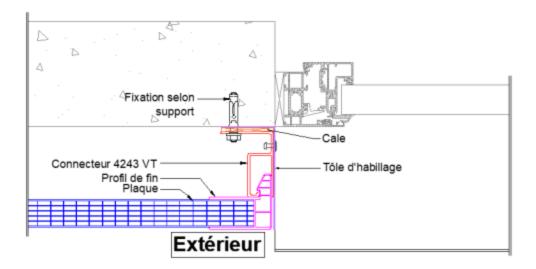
Encadrement d'une baie en tunnel avec plaque ajustée - Coupe horizontale
